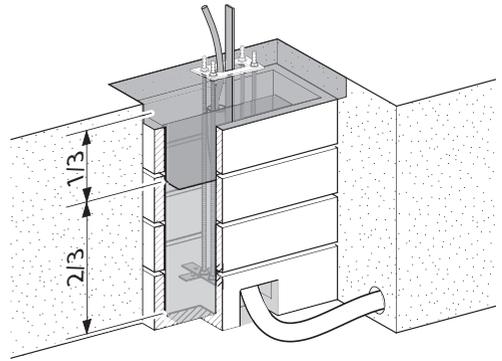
Bétonnage des fondations (exemple : AMEDIO®)
